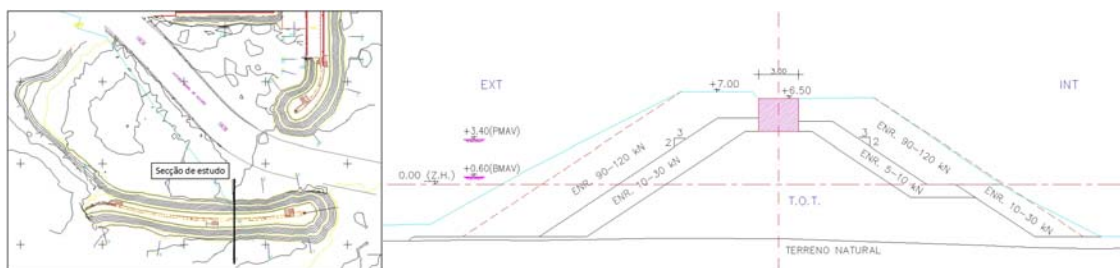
Planta do Porto de Albufeira: Posição e perfil da secção de estudo.
